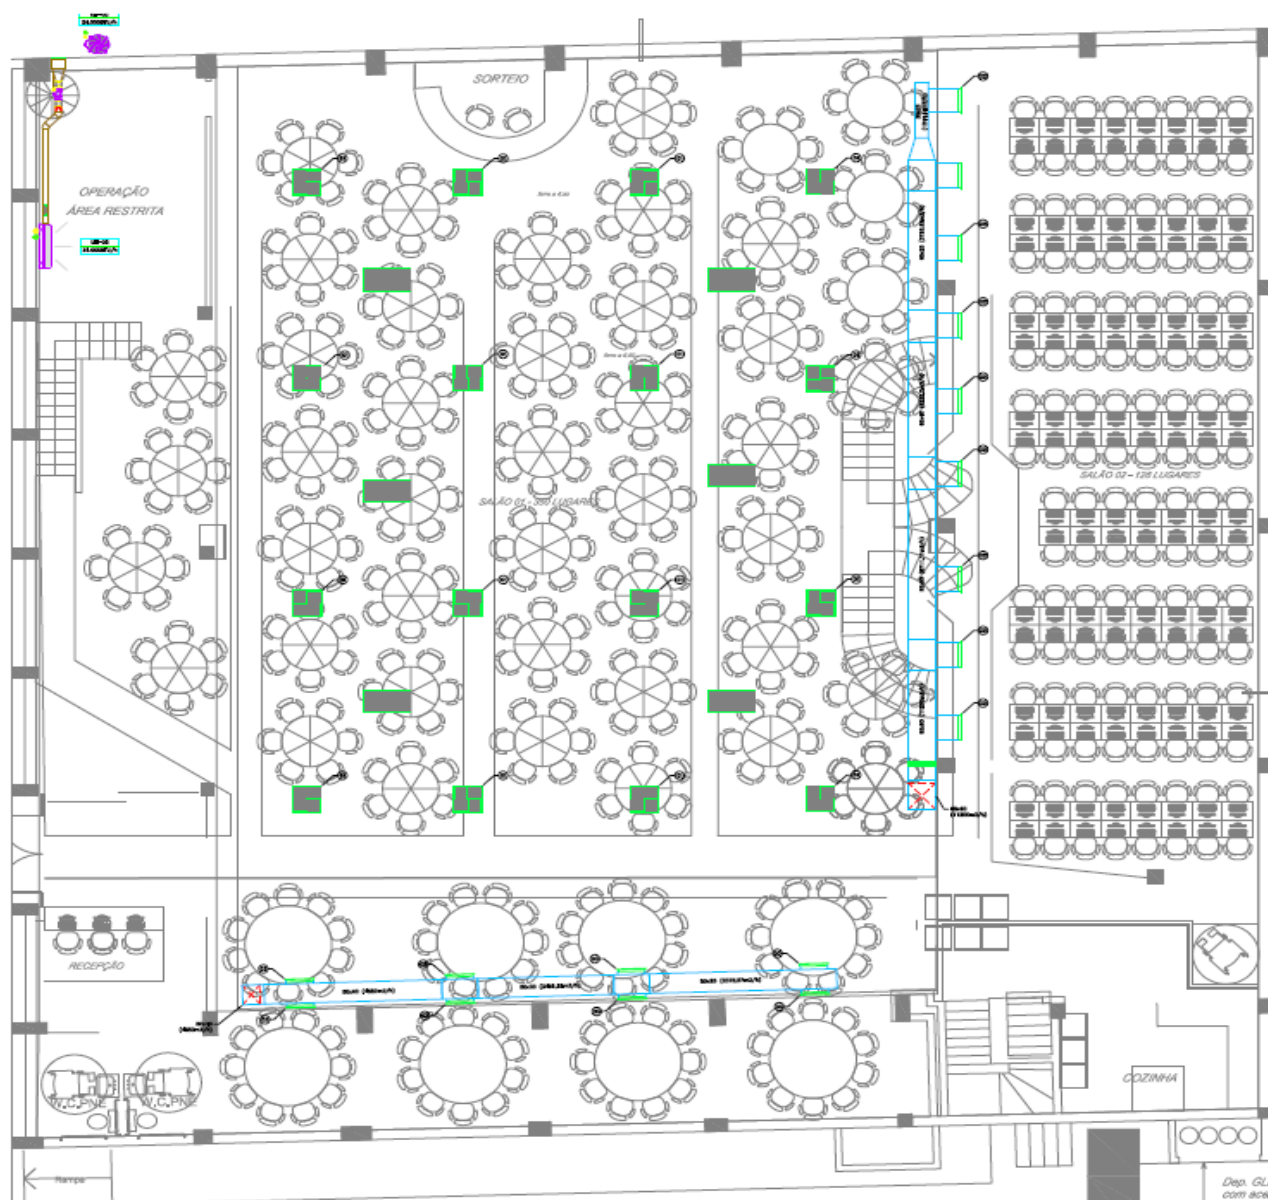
Planta baixa da sala de jogos com o sistema de ar-condicionado desenhado.
